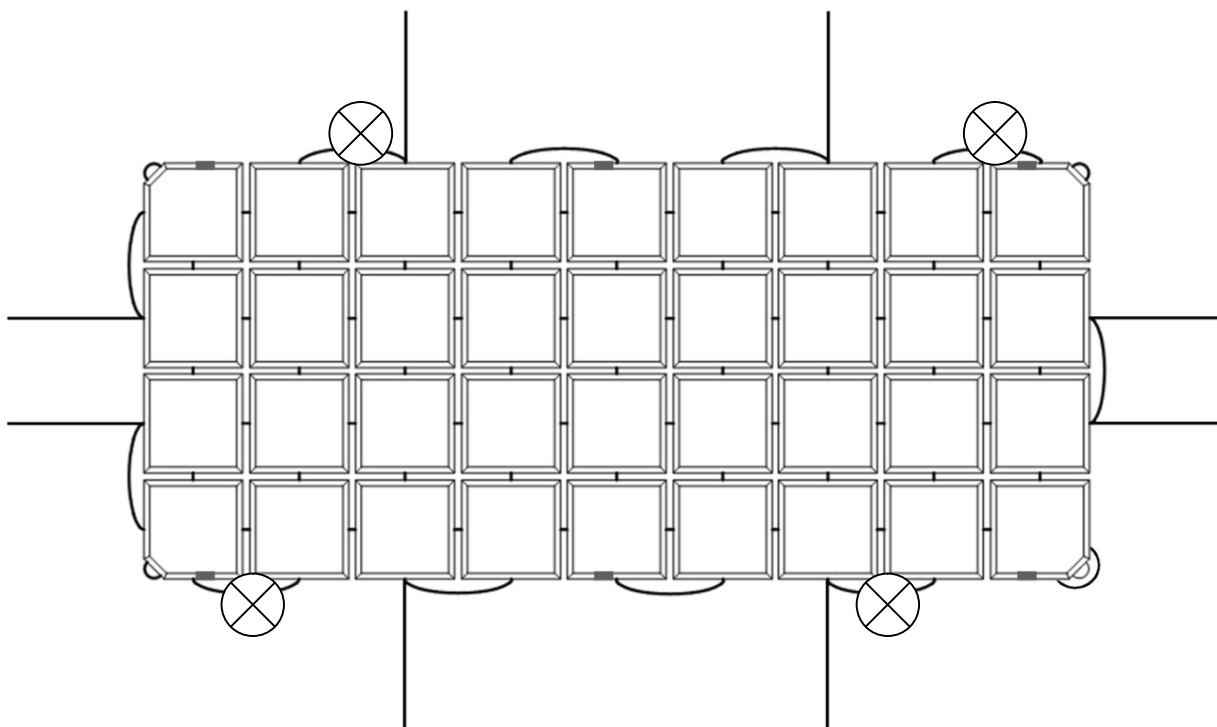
Места строповки гибкой бетонной плиты за четыре петли
